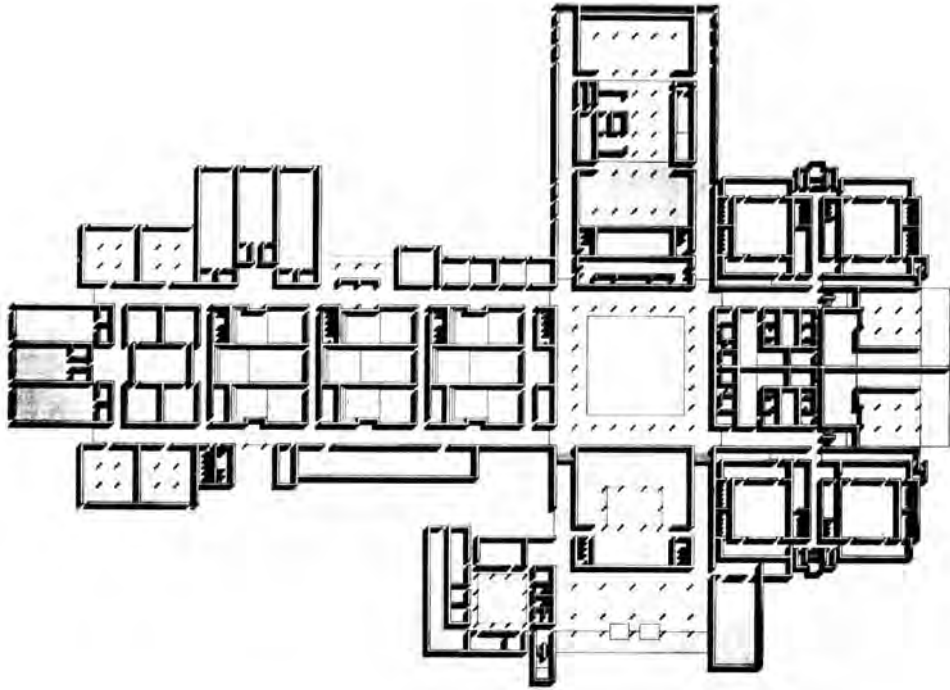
Planta UL de Almería, publicada en la revista *Arquitectura* n. 198.
